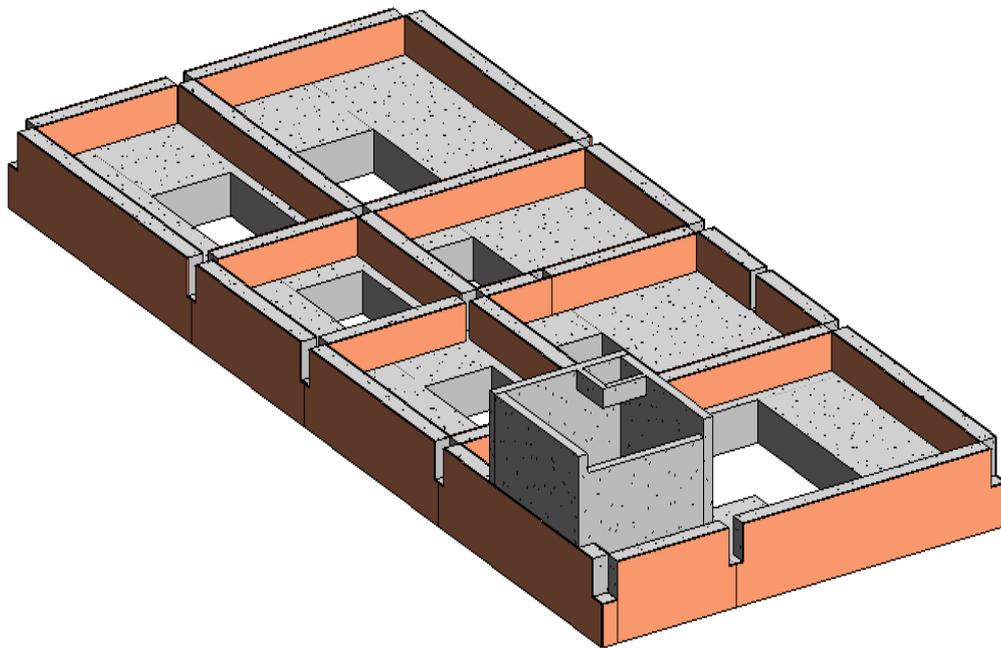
Modelo Virtual de los Elementos de Aligerado
